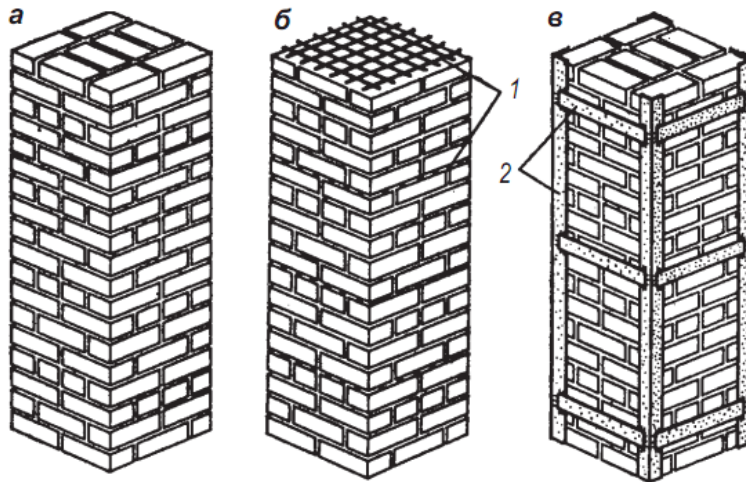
Цегляні стовпи: а – неармований; б – армований сіткою; в – зміцнений обоймою із кутиків і планок; 1 – сітка з дроту діаметром 5 - 6 мм; 2 – обойма із кутиків і планок
